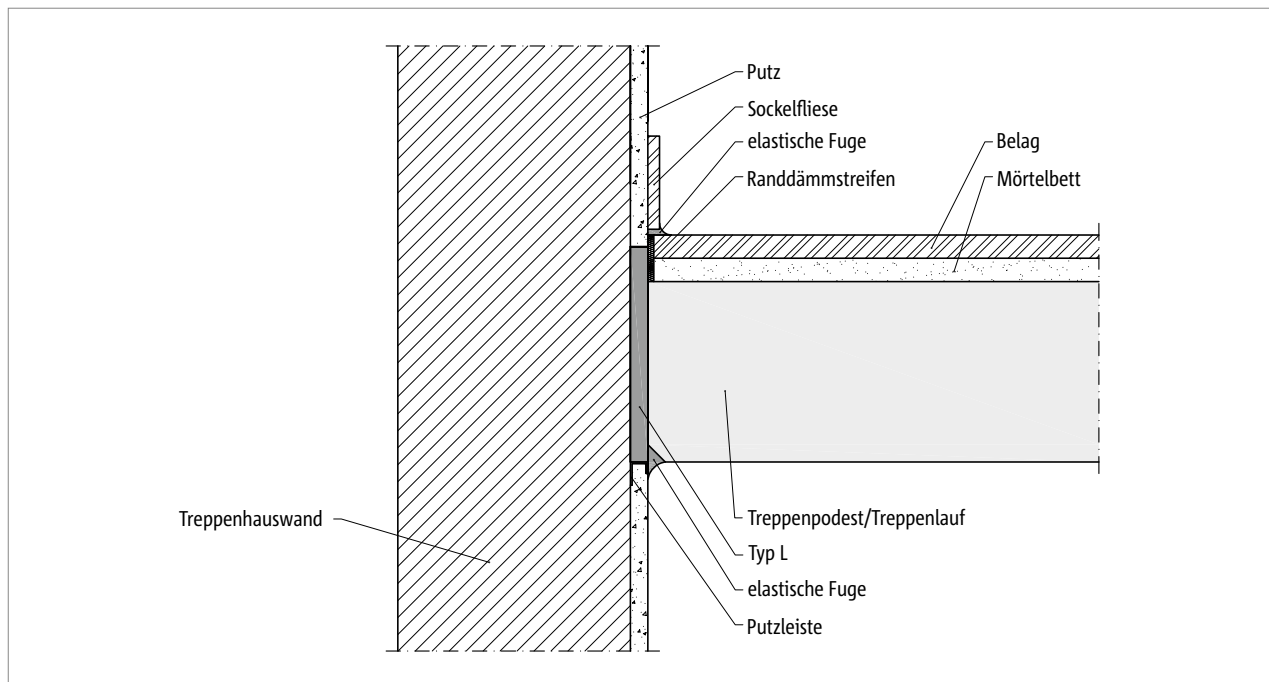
Schöck Tronsole® Typ L: Einbauschritt Elementtreppe
